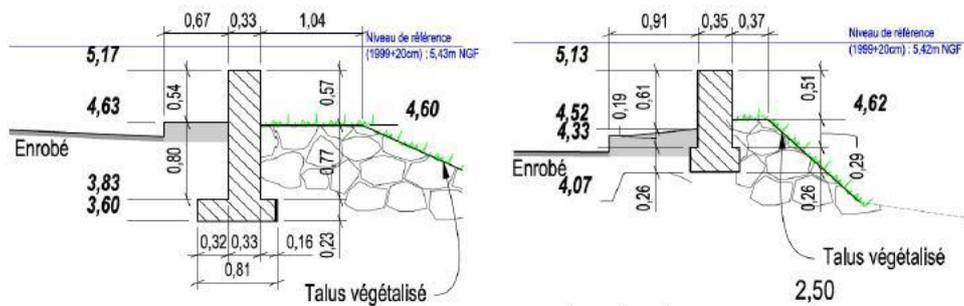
Profils en travers des murets béton sur le tronçon 3
